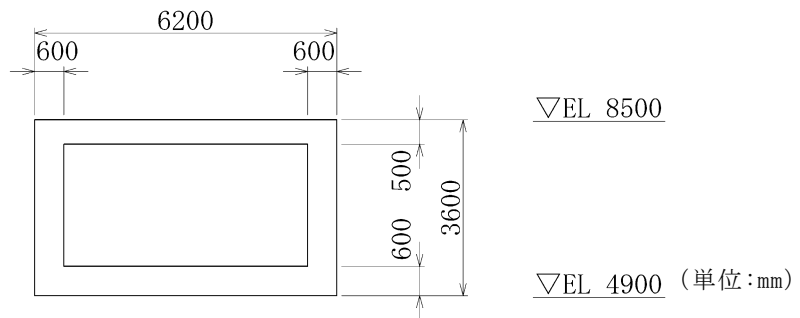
屋外配管ダクト (タービン建物～排気筒) 断面図 (D-D 断面)
